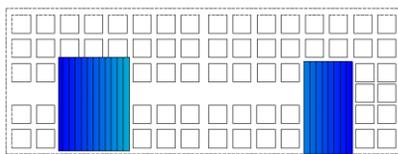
PLAN DE TOITURE DE LA TERRASSE
